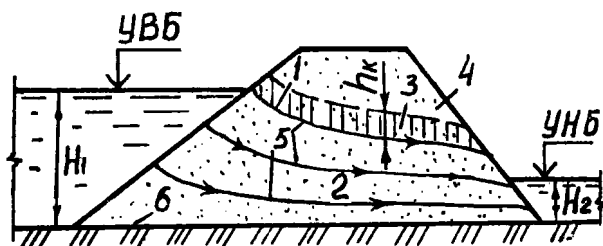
Схема фильтрации воды через тело плотины на водонепроницаемом основании: 1 – кривая депрессии; 2 – зона полного насыщения грунта водой; 3 – зона частичного насыщения грунта водой за счет капиллярного поднятия; 4 – зона воздушно-сухого грунта; 5 – линии токов; 6 – водонепроницаемое основание – водоупор; h_k – высота капиллярного поднятия
